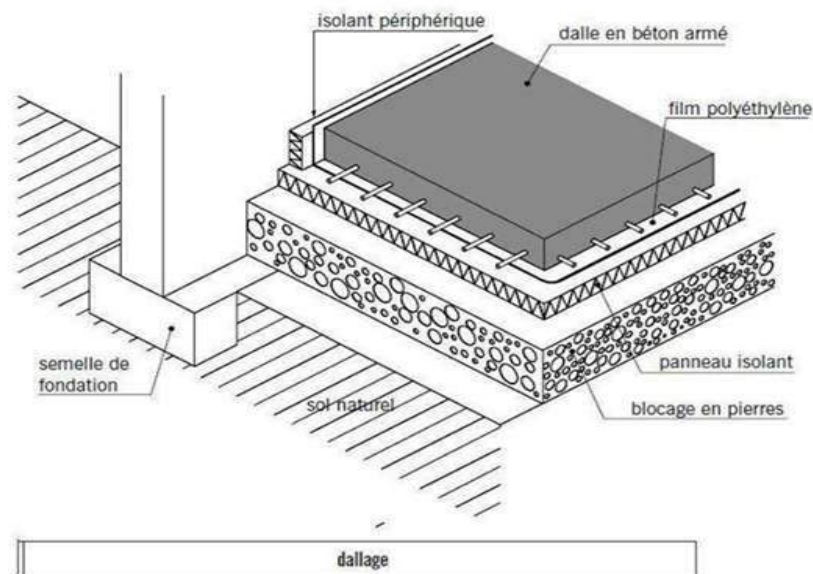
Schéma d’un plancher à dalle pleine. [4]
